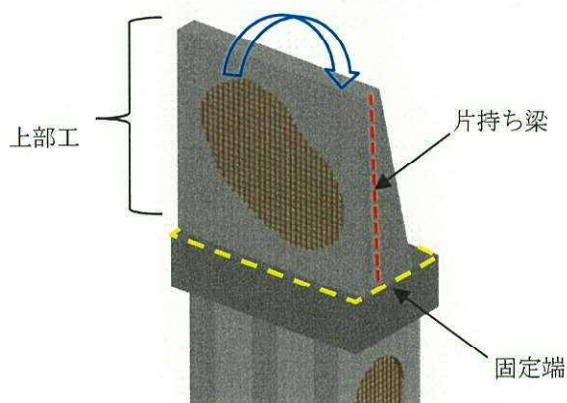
鉄筋コンクリート防潮壁の上部工[一般部]
